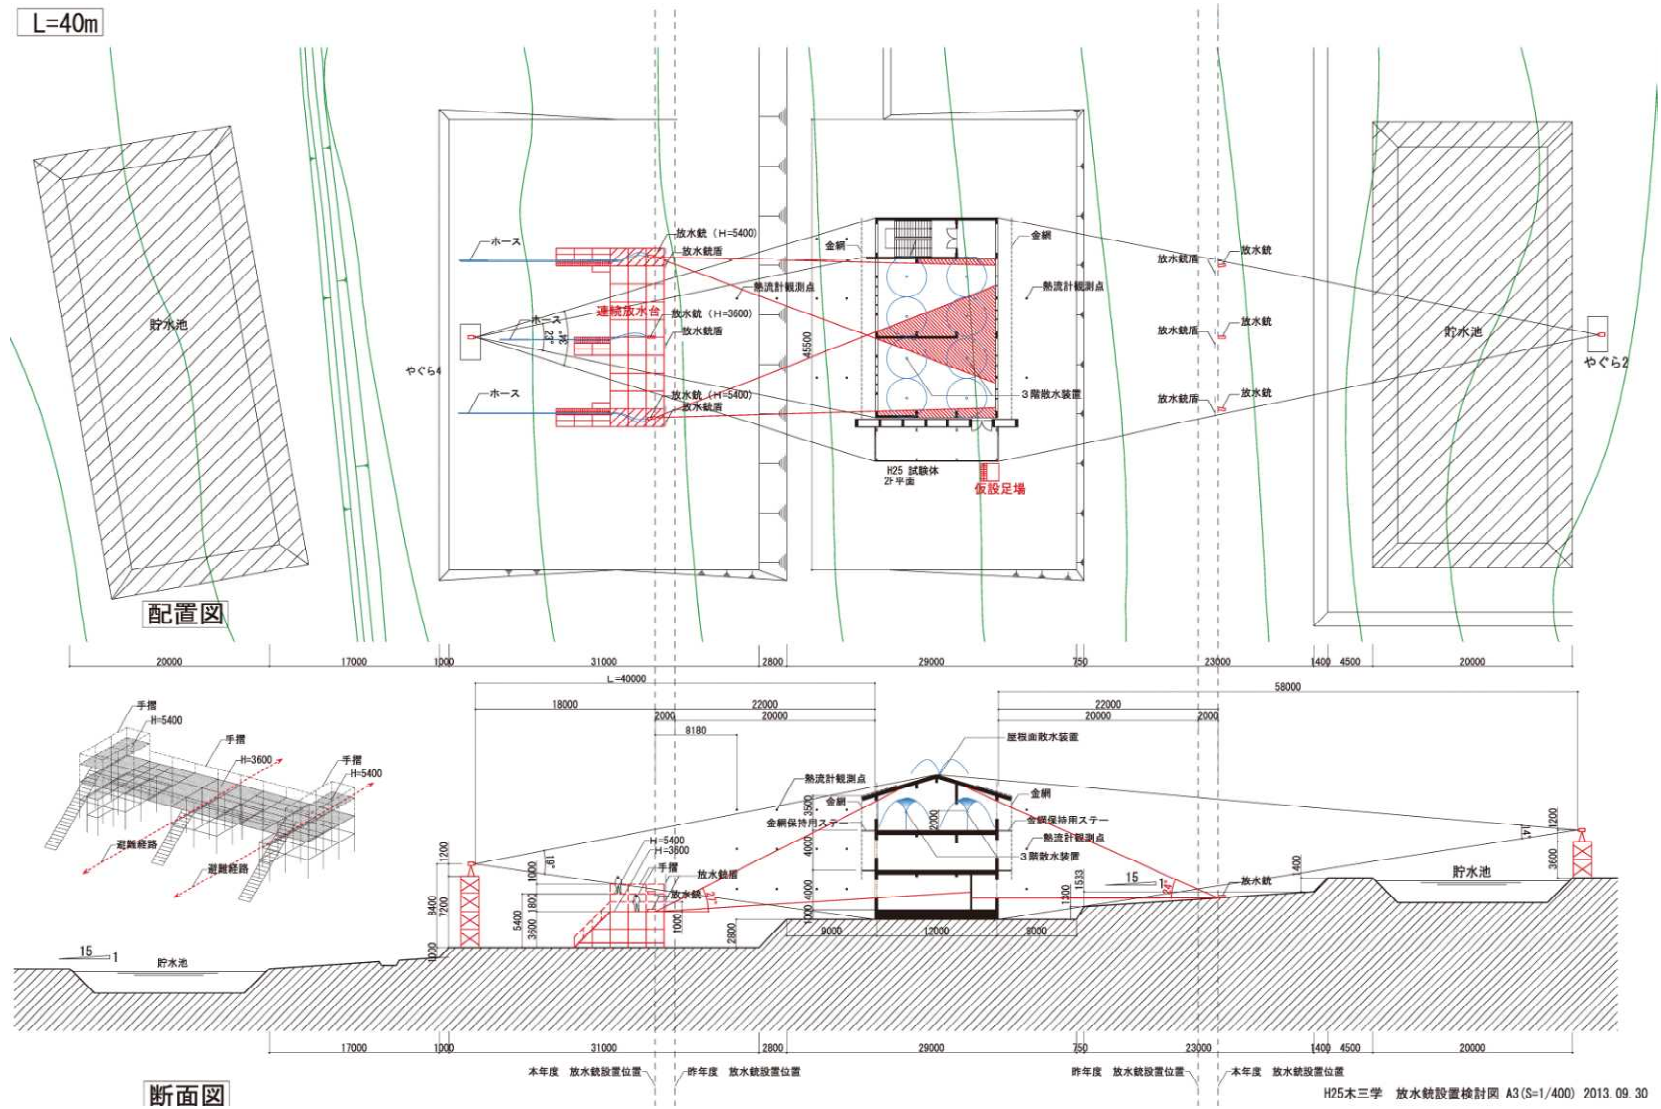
実験建物消火用放水台平面図・断面図
